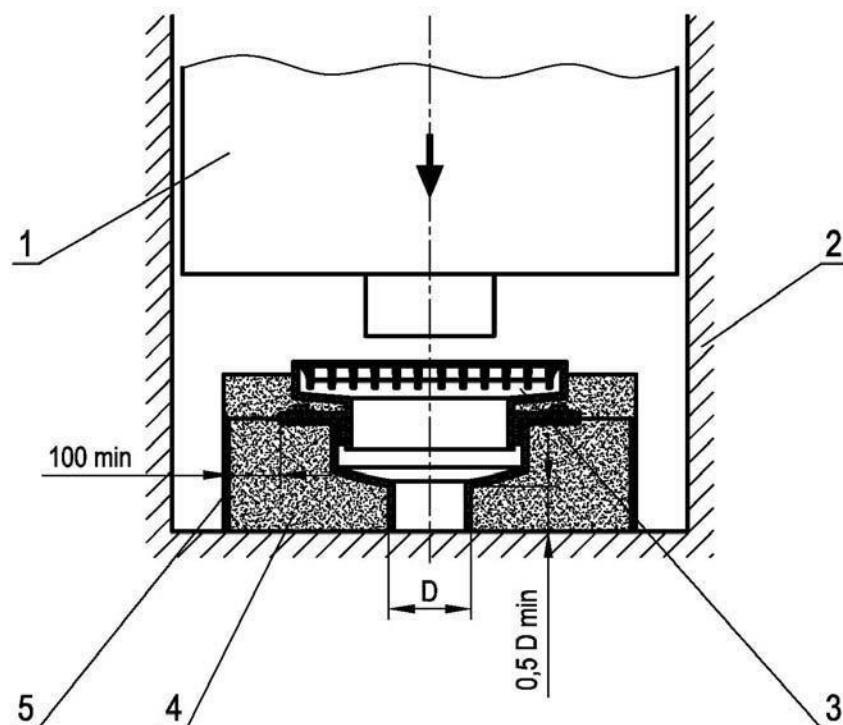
Схема испытаний на класс нагрузки трапа для железобетонных строений (1 – ползун пресса, 2 – станина пресса, 3 – испытываемый трап, 4 – бетонный блок, 5 – бандаж).
